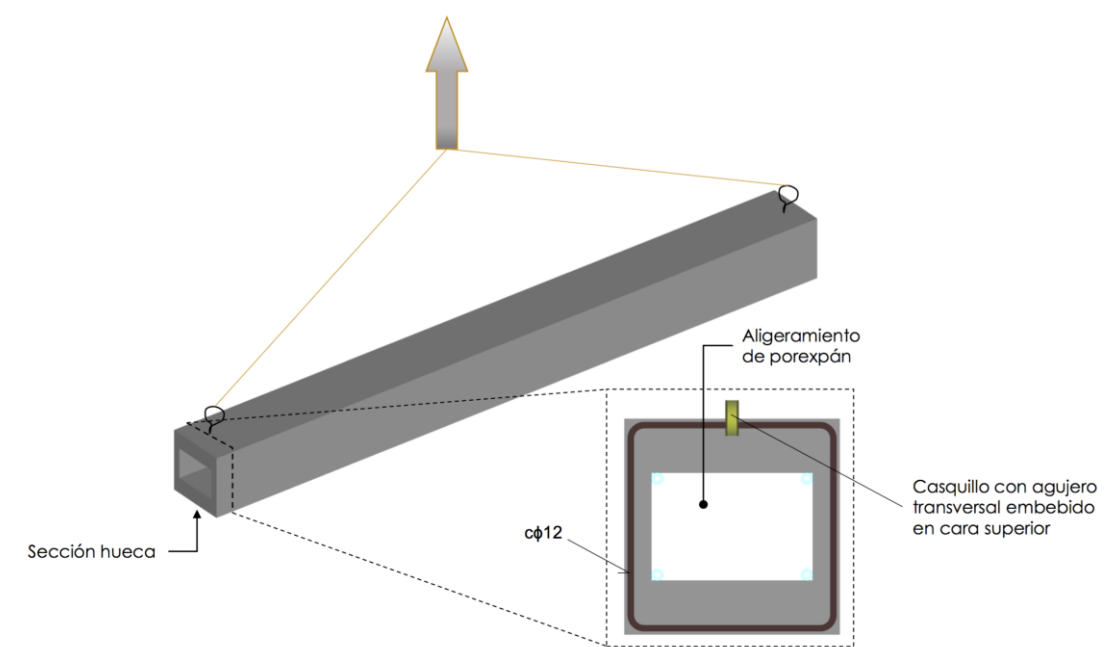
Izado y detalles constructivos de elementos centrales del arco
